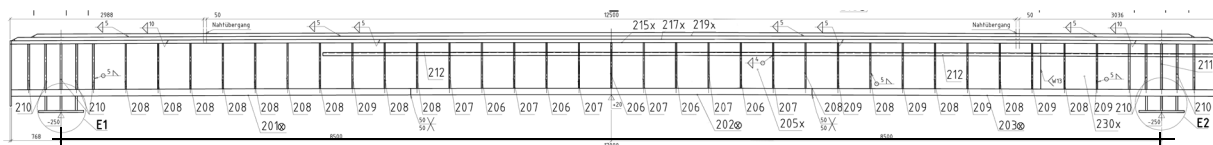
Auszug aus einer Fertigungszeichnung [12], Brückenansicht
